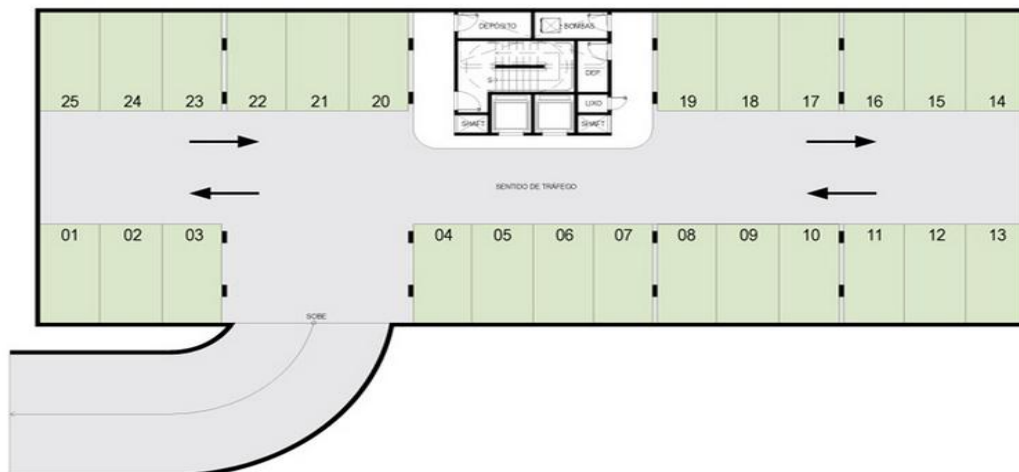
Planta baixa de um dos pavimentos para garagem. Fonte: MValle Construtora.
